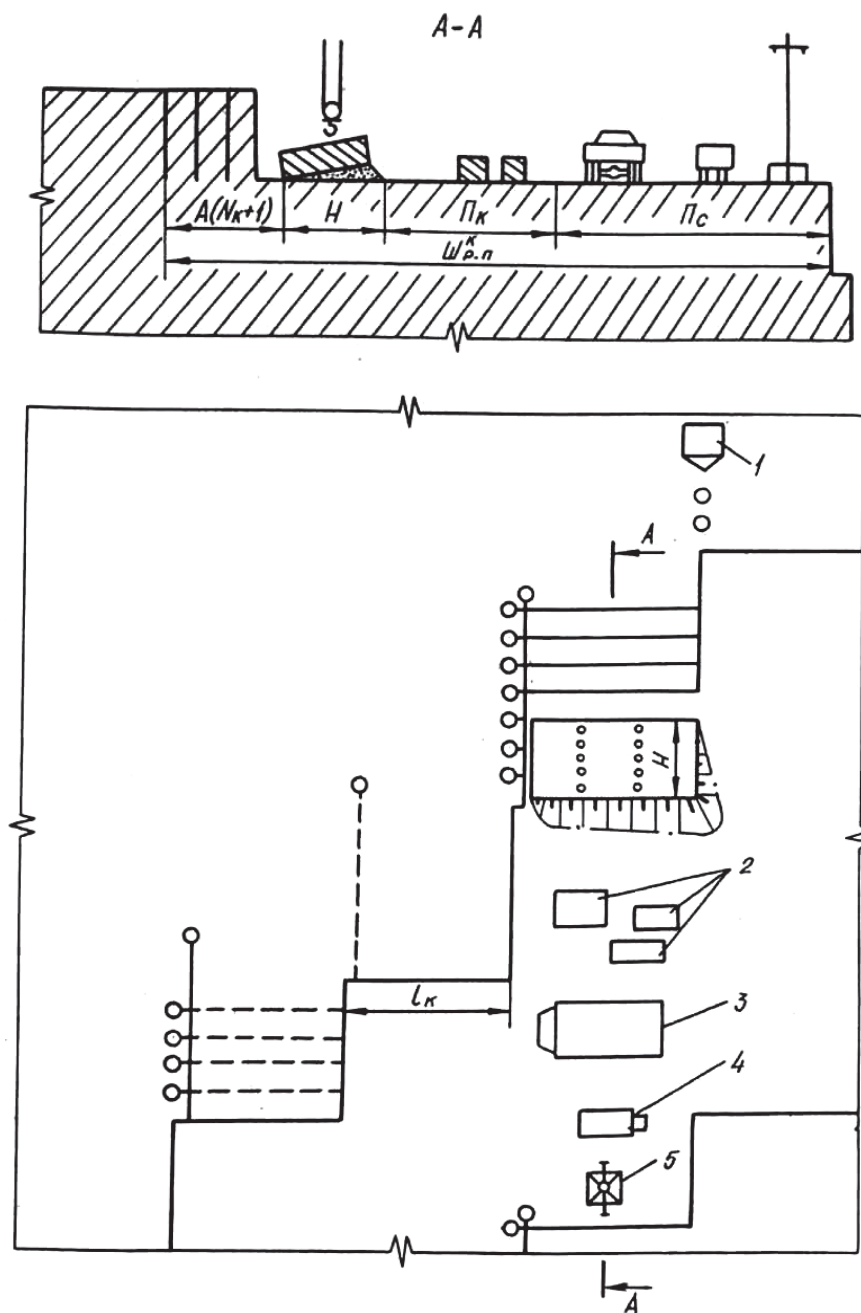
Схема к расчету ширины рабочей площадки при добыче блоков канатными пилами: 1 – буровой станок; 2 – блоки; 3 – автосамосвал; 4 – компрессор; 5 – опора ЛЭП
